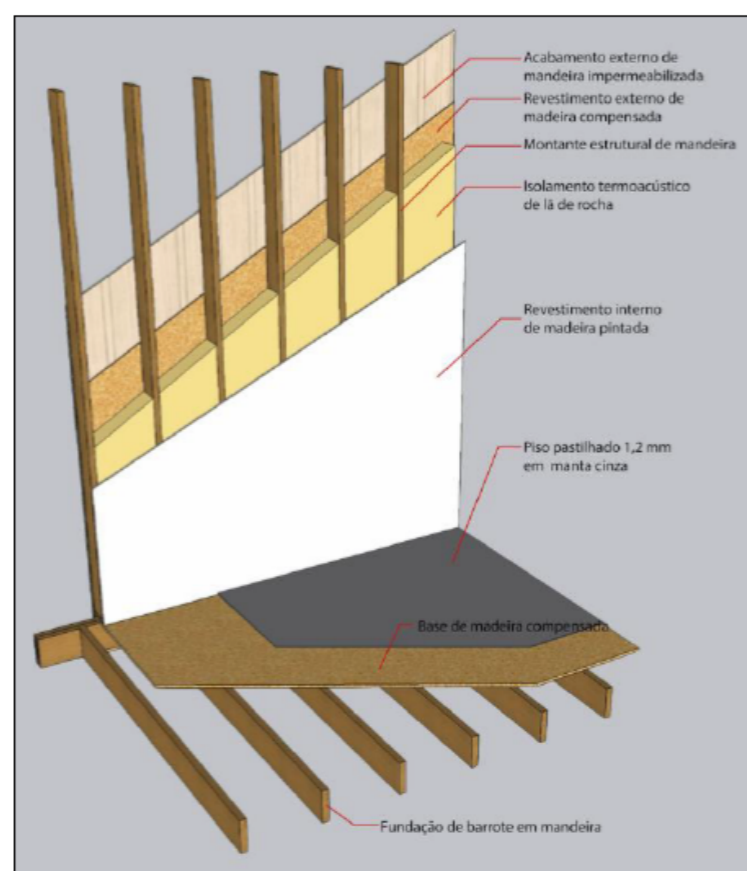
Detalhe parede e piso. Fonte: Tecverde, 2016.
